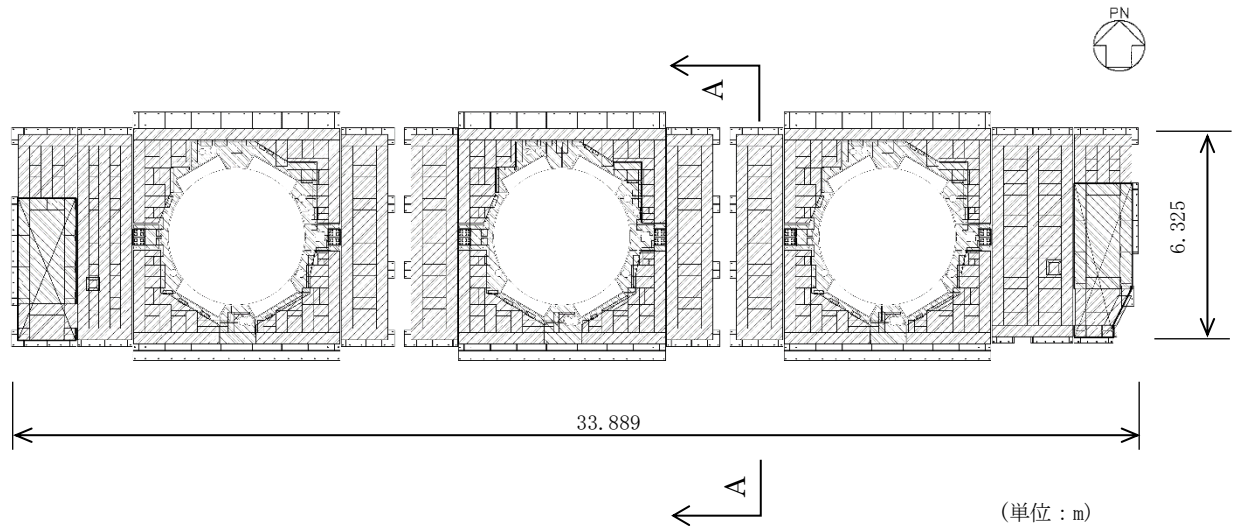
取水槽循環水ポンプエリア竜巻防護対策設備の平面図
